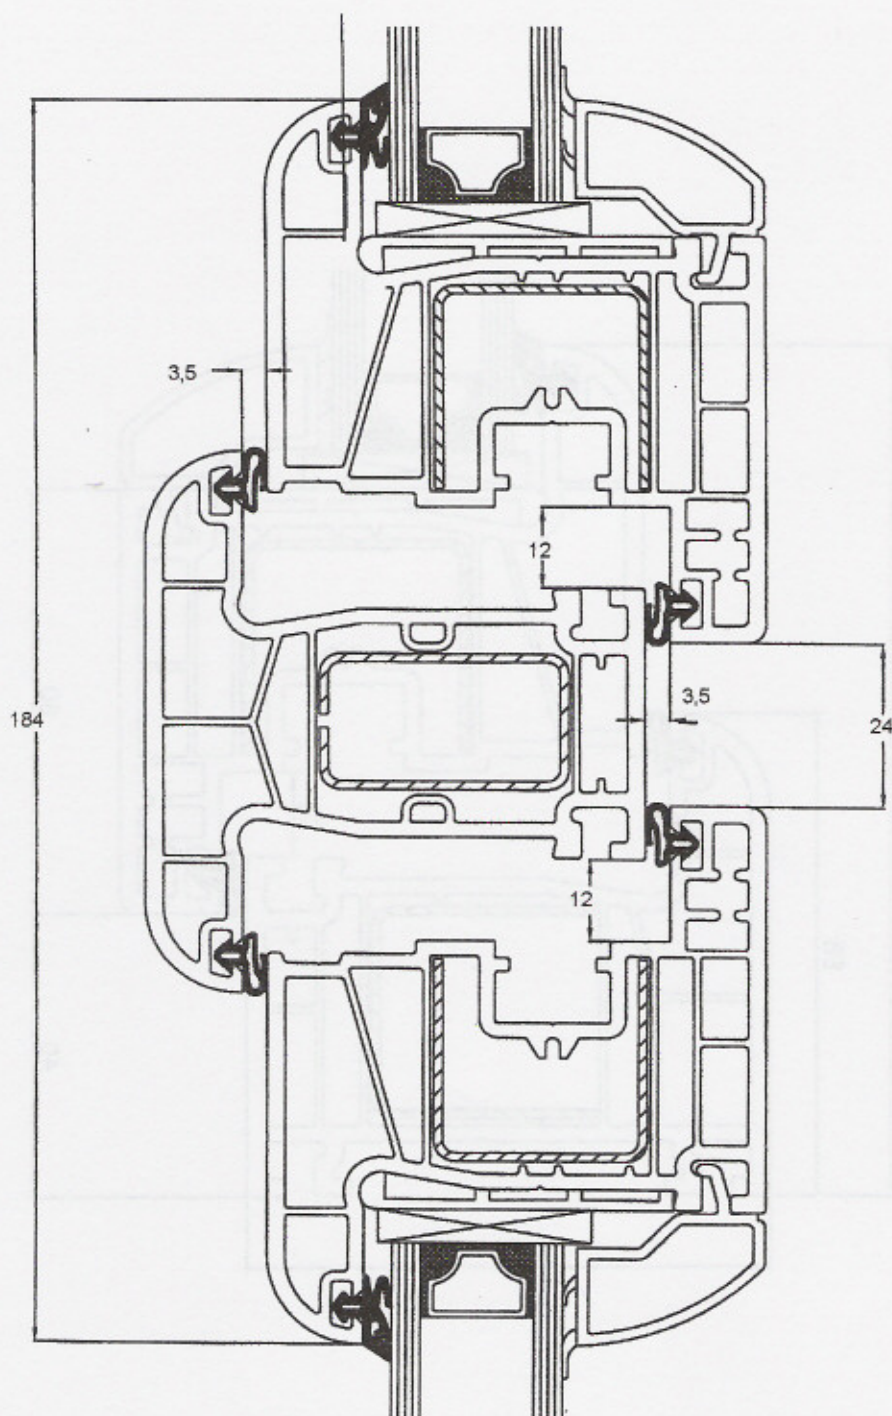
Przekrój przez ramę 7010 T okien stałych
